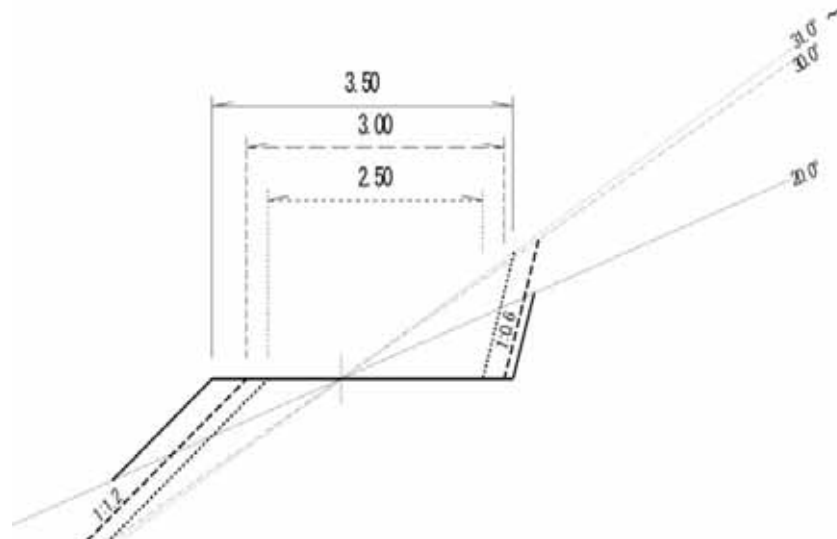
森林作業道の標準断面図（内楽木・砥森地区採用）
